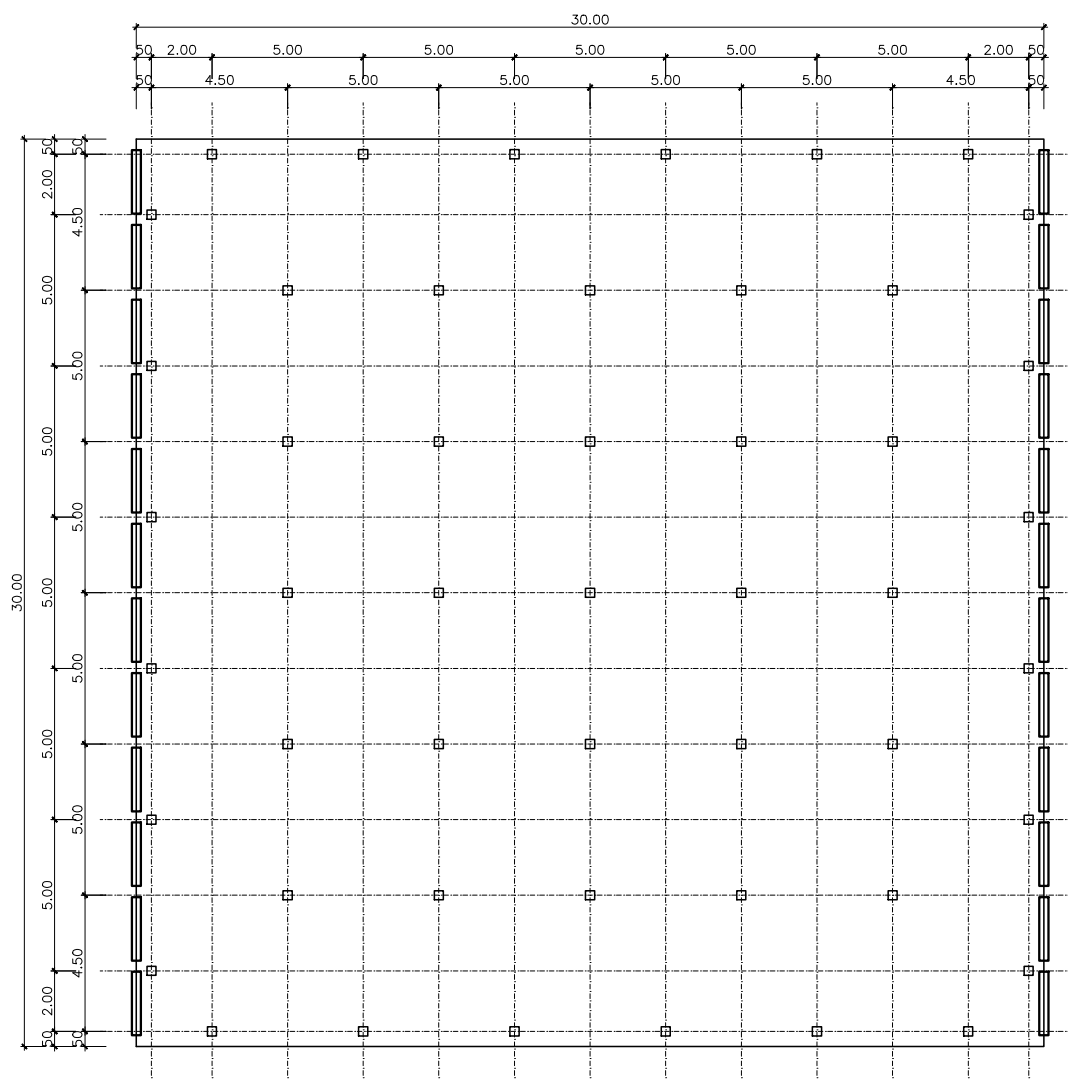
Regelgeschoss – Holzskelettbau 1:1, Maße in [m]
